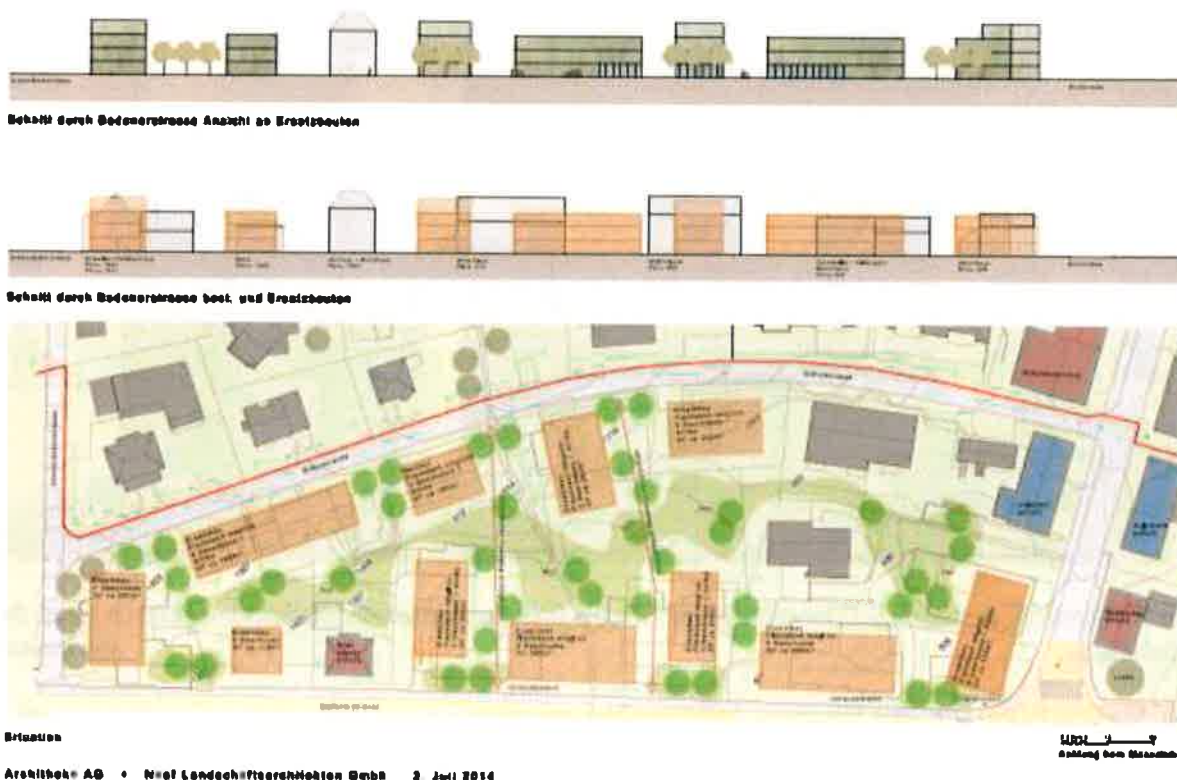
Richtkonzept Badenerstrasse K268 – "überzeugende Grundlage für den Rahmengestaltungsplan
